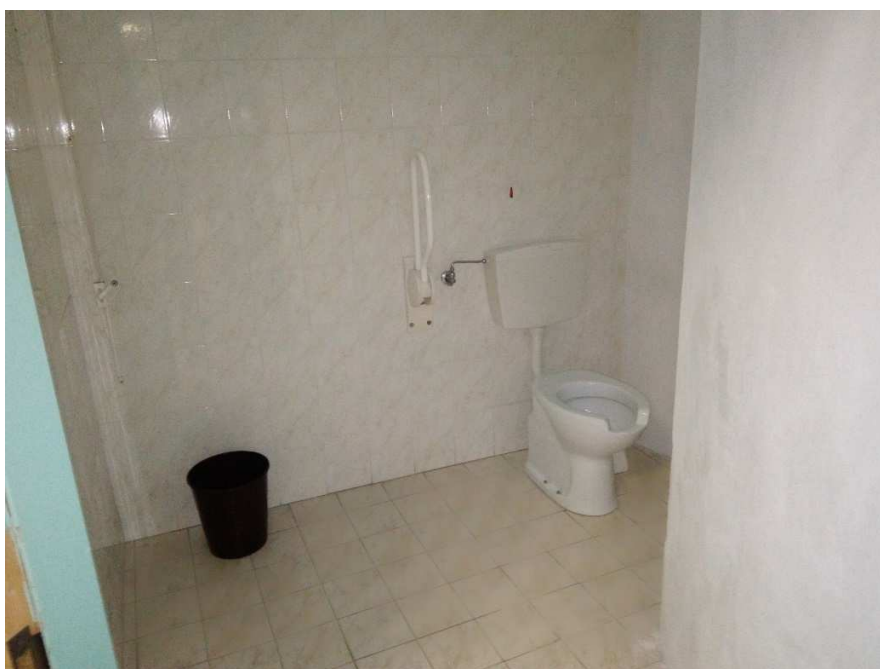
FOTO X – BAGNO DONNE – VISTA SERVIZIO DISABILI ATTUALE
